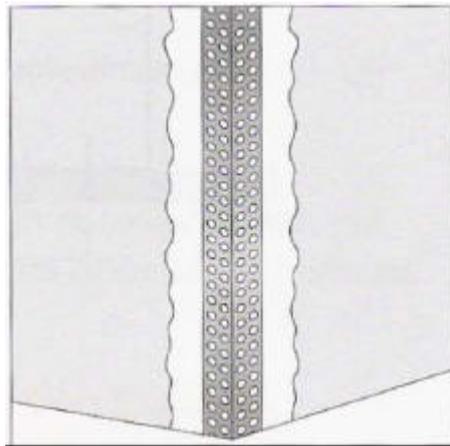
Cantoneira metálica perfurada. Fonte: Abragesso, 2004.
